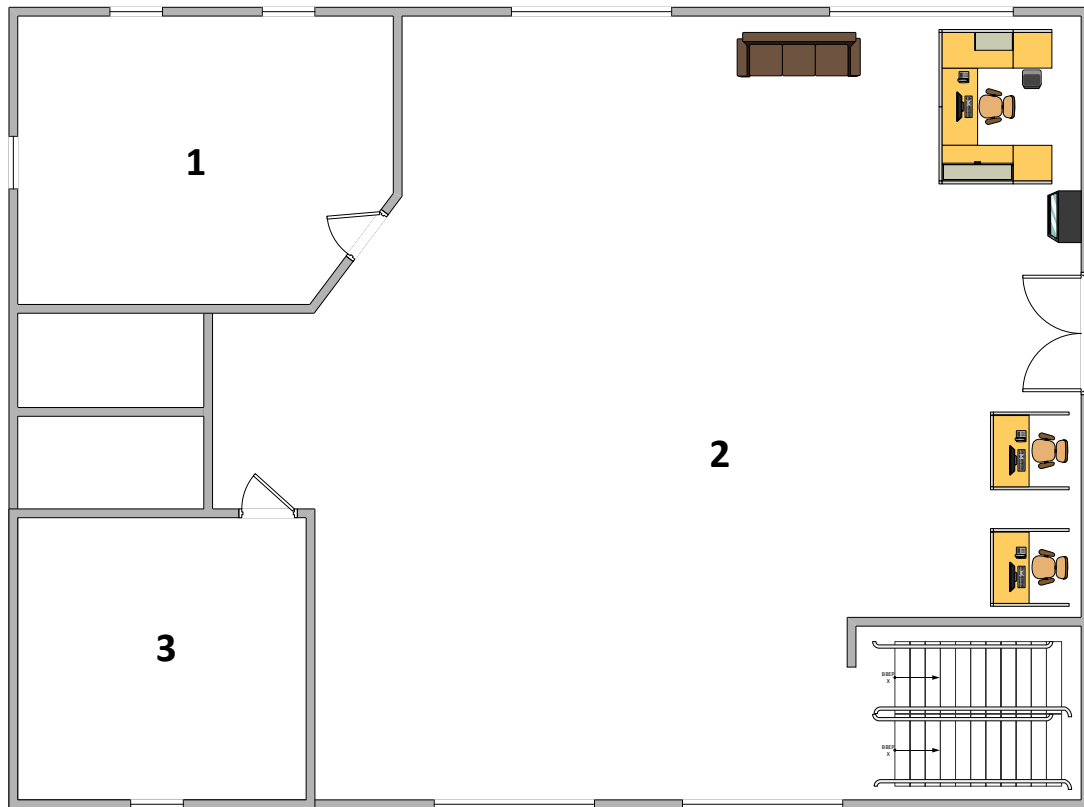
Топологічна схема, перша будівля поверх 1
